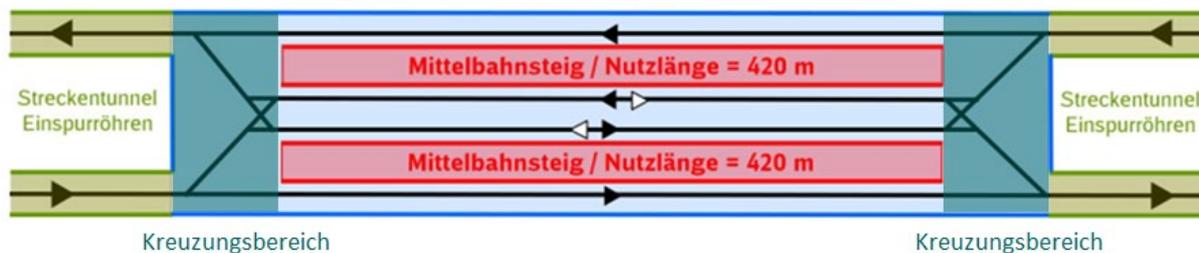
Schema Station mit zwei eingleisigen Tunnelröhren
